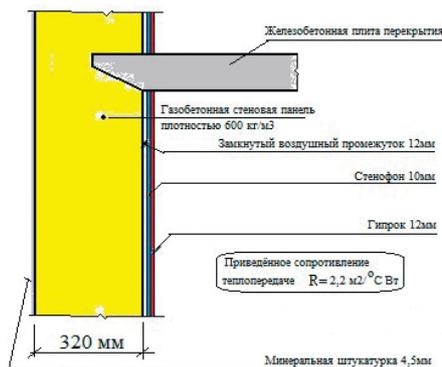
Усовершенствованная конструкция стен жилых зданий из газобетонных панелей
